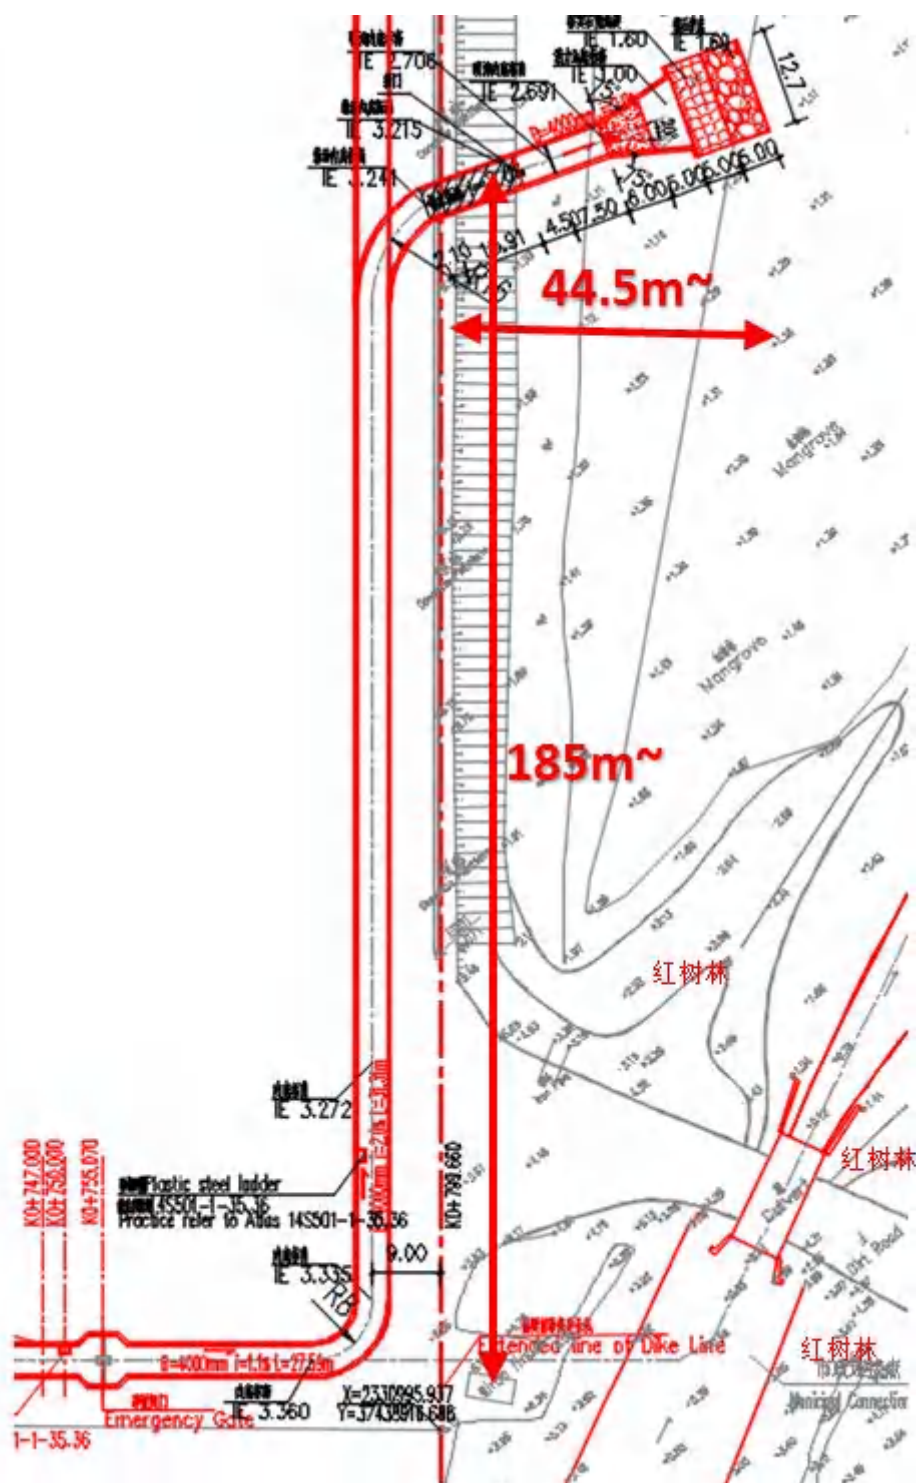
方案 A (备选方案) 东侧雨排 1#平面布置图
